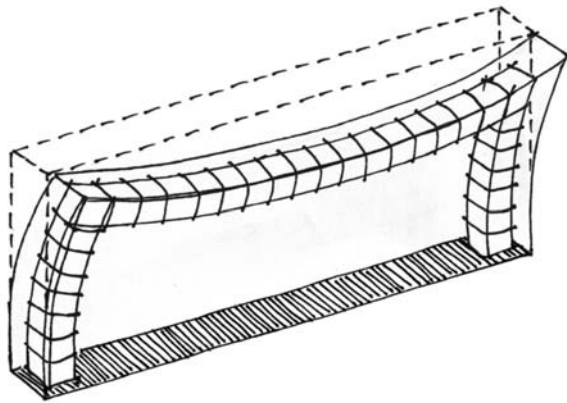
Continuité mécanique entre les chaînages verticaux et horizontaux.
